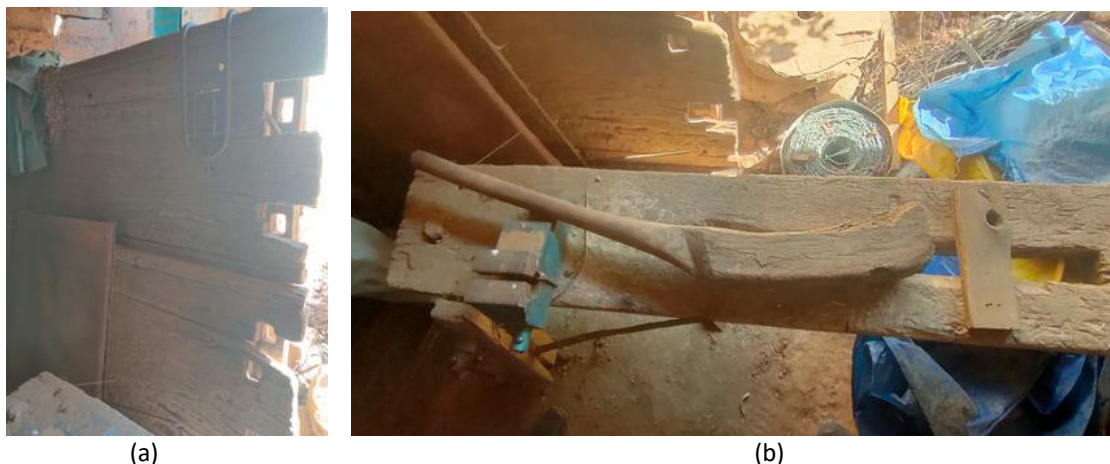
Materiales para el tapial: a) encofrado de madera (maestras) y b) apisonador (macho)
